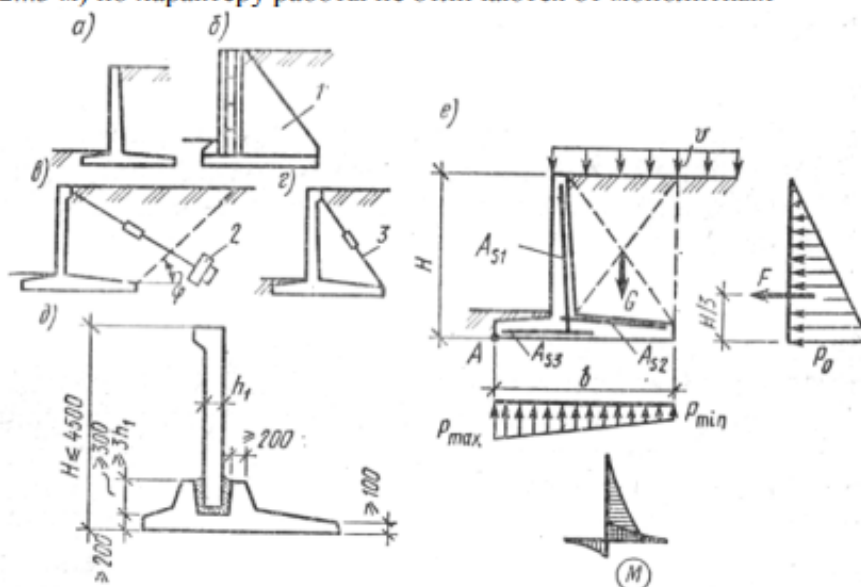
Конструктивные решения подпорных стен (а...д) и схема армирования уголковой подпорной стенки (е): 1 — контрфорс; 2 — анкер; 3 — тяж
